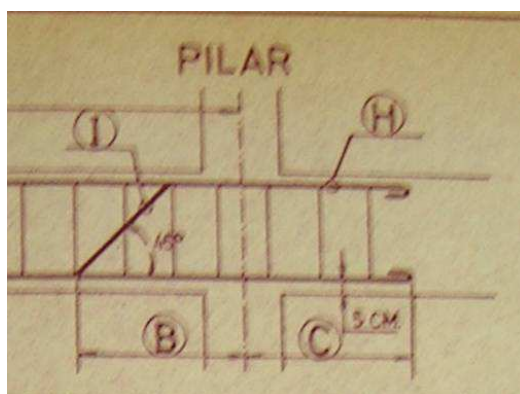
Detalle de nudo de armados en vigas. Edificio ficha 221C.019, 1972.
